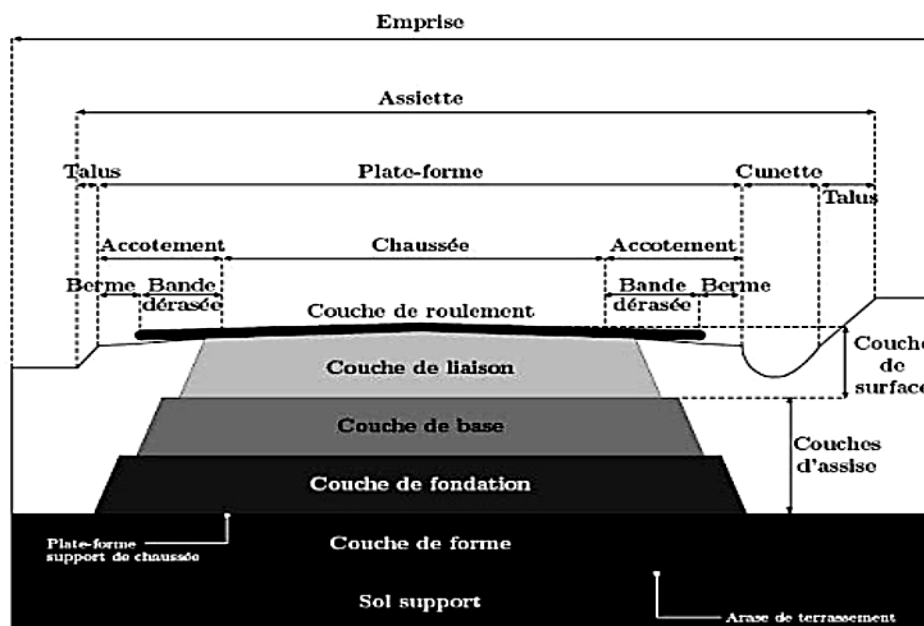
Coupe transversale d'une chaussée. [EHG, 2010]
